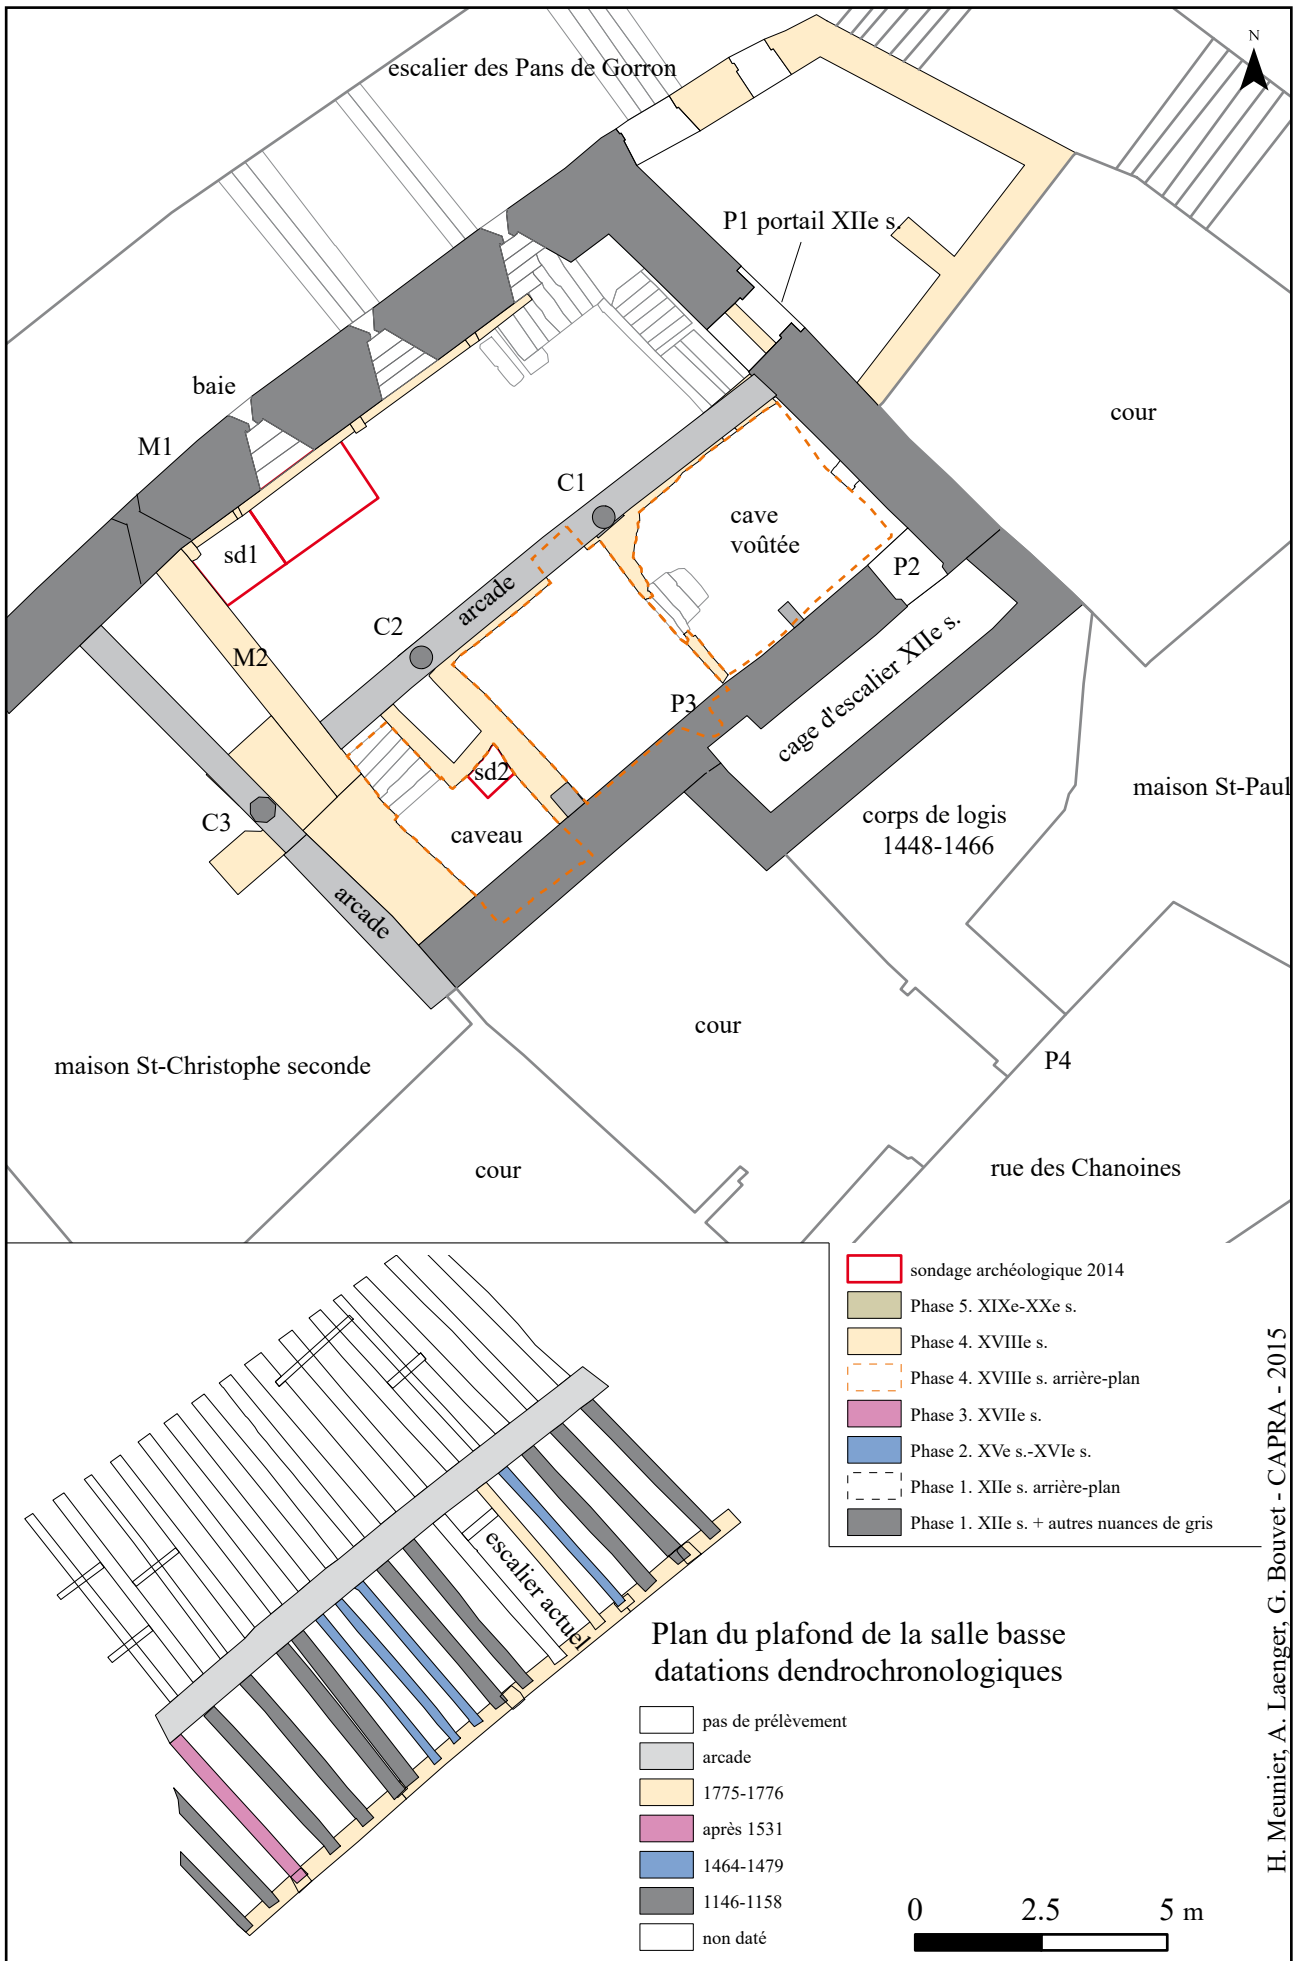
Plan de la salle basse Saint-Pierre : rez-de-chaussée + 1, avec les transformations du XVIII^e s. Etat actuel d'après les relevés au scanner 3D
